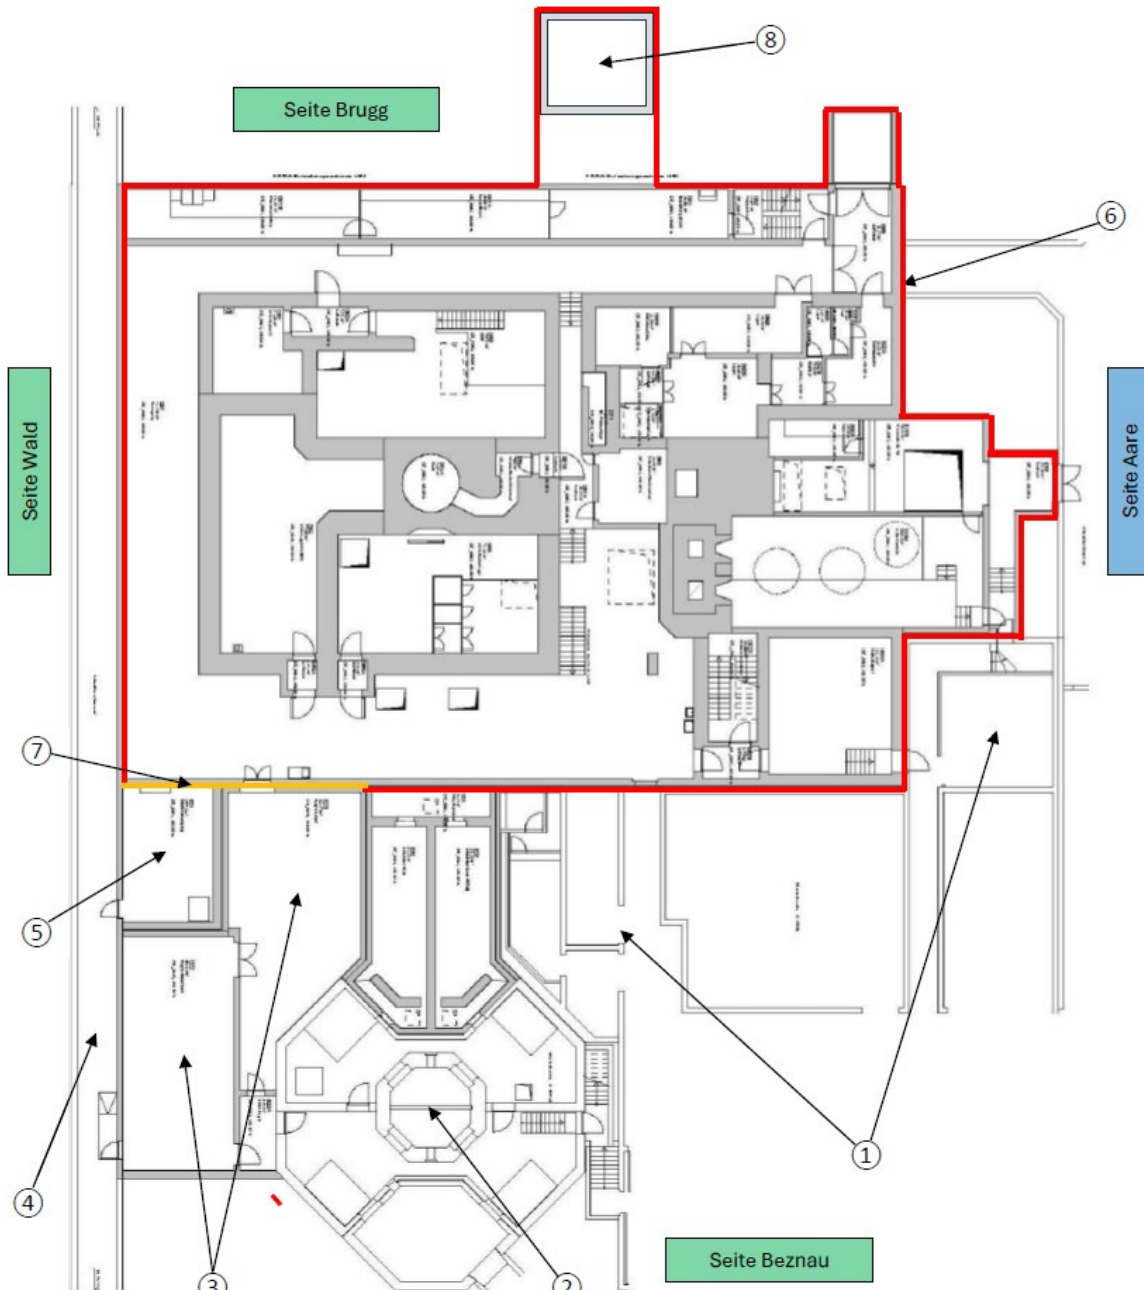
Grundriss des ersten Untergeschosses des Gebäudes ODRA mit Perimeter
